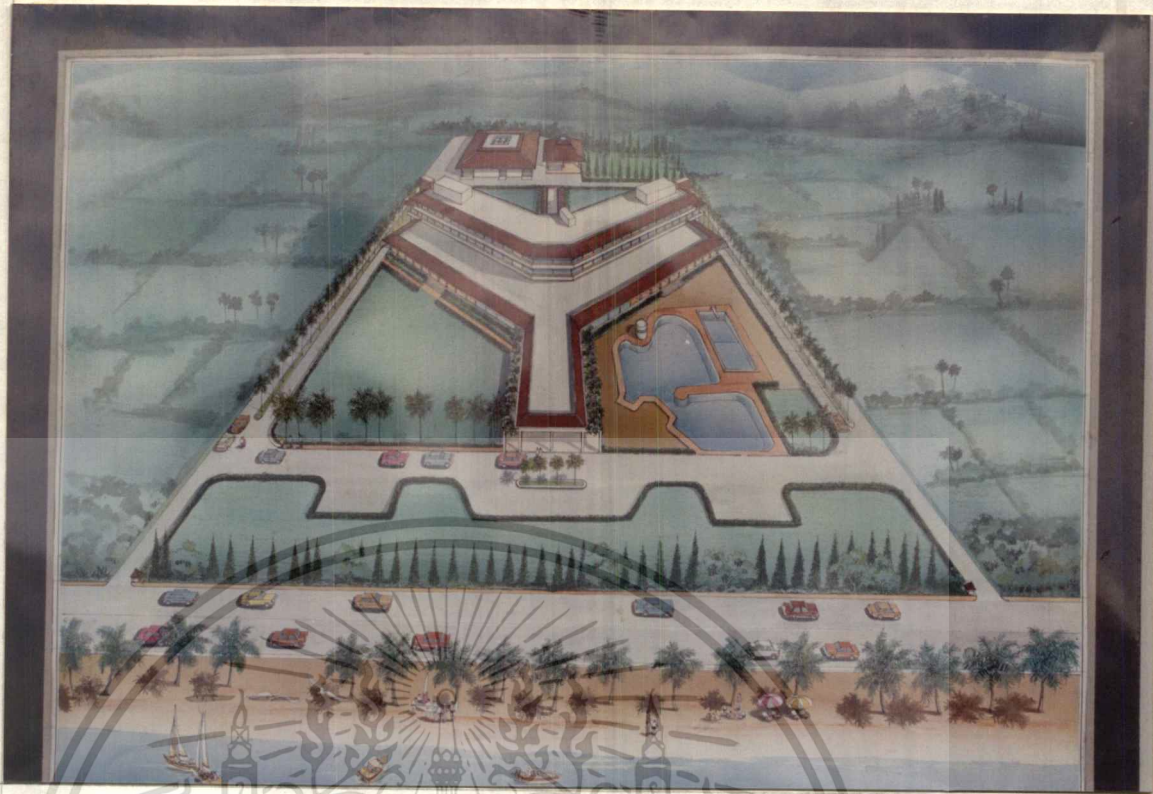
แสดงรูปด้าน (ELEVATION)
